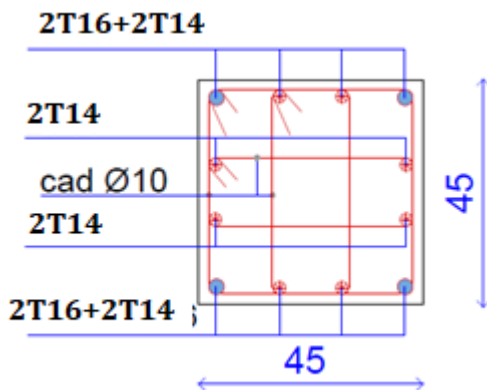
Schéma de ferrailage des poteaux (45*45) cm² de 3^{ème} et
